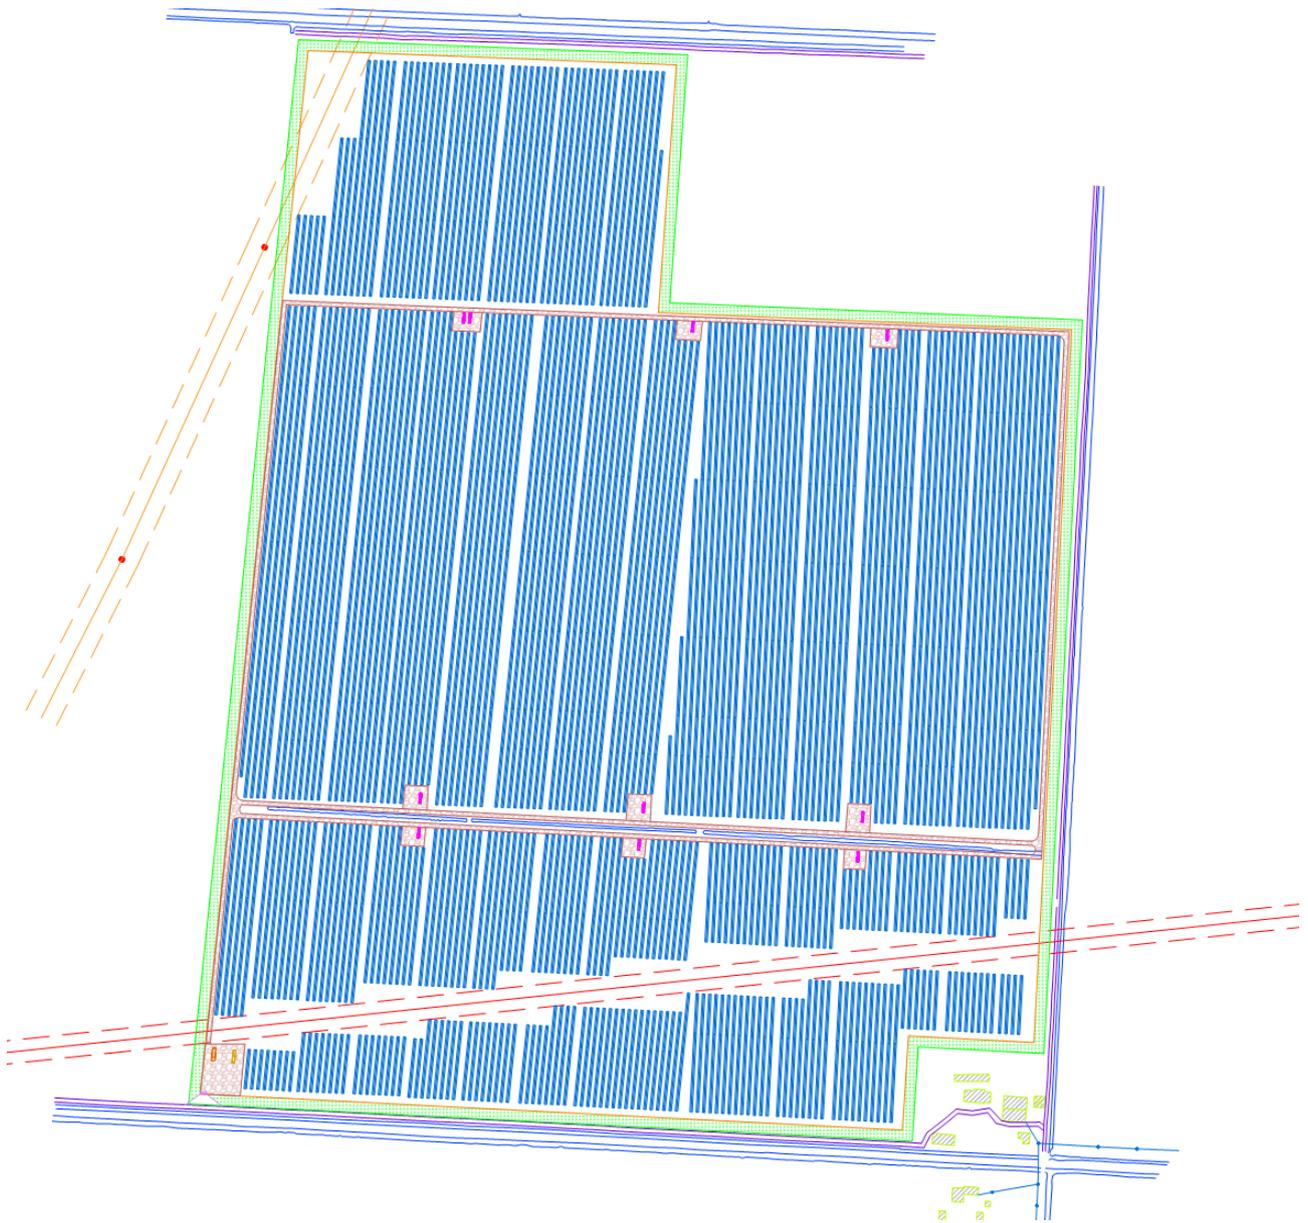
Configurazione sezione Ovest dell'impianto agrovoltaico
